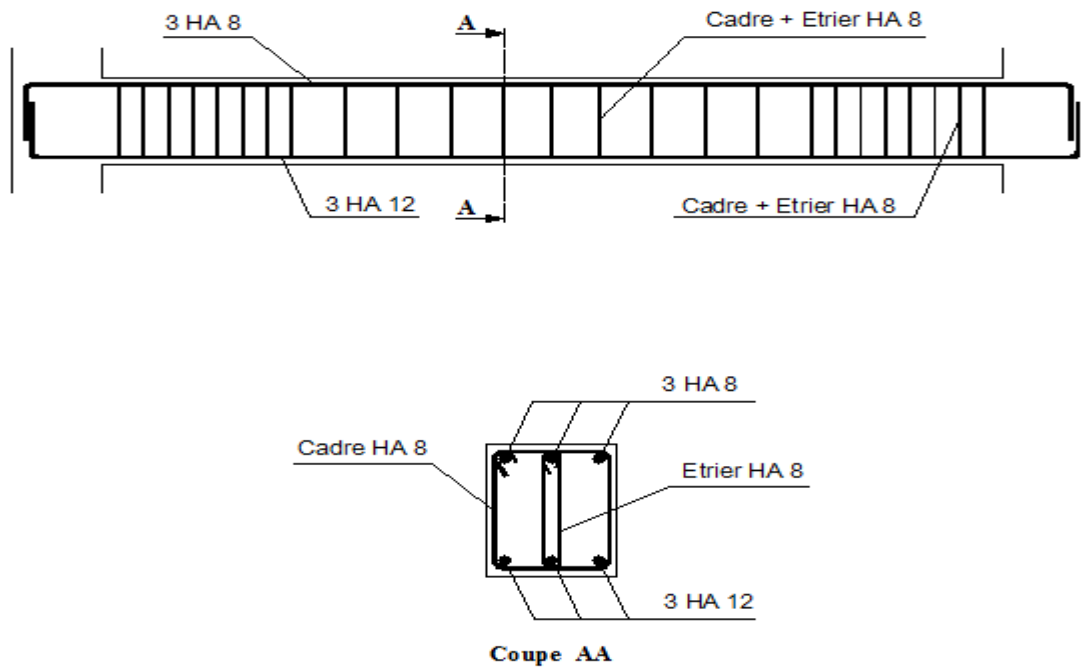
Ferrailage de la poutre de chaînage reposant sur deux appuis.
